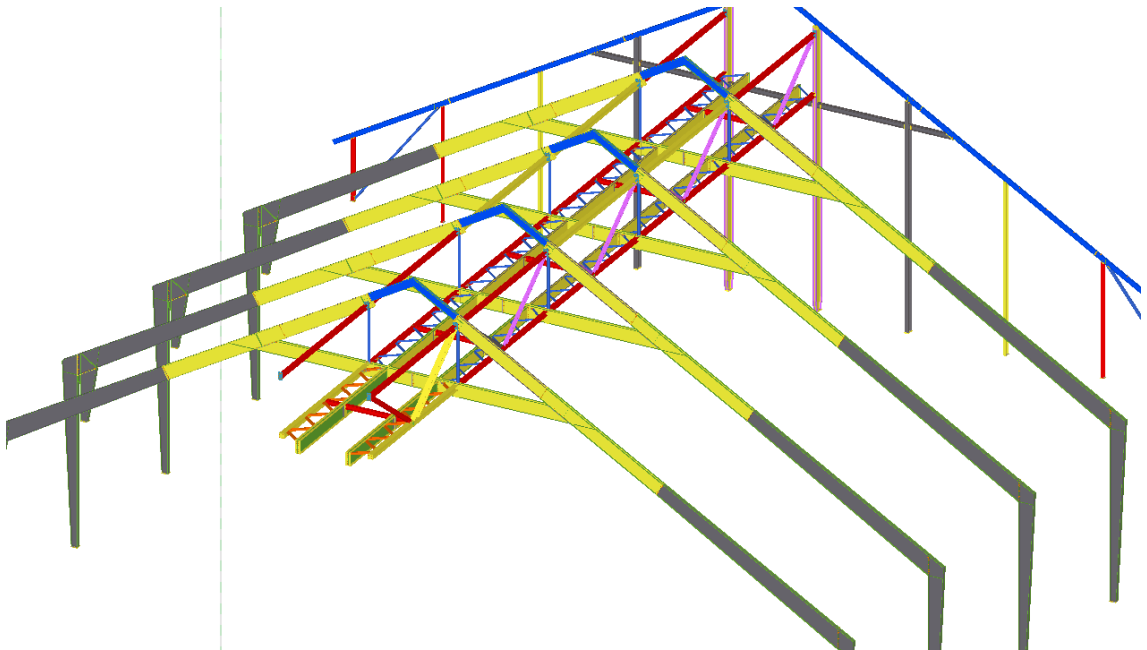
Pórtico armado provisto con estructura para tripper para distribución de material
